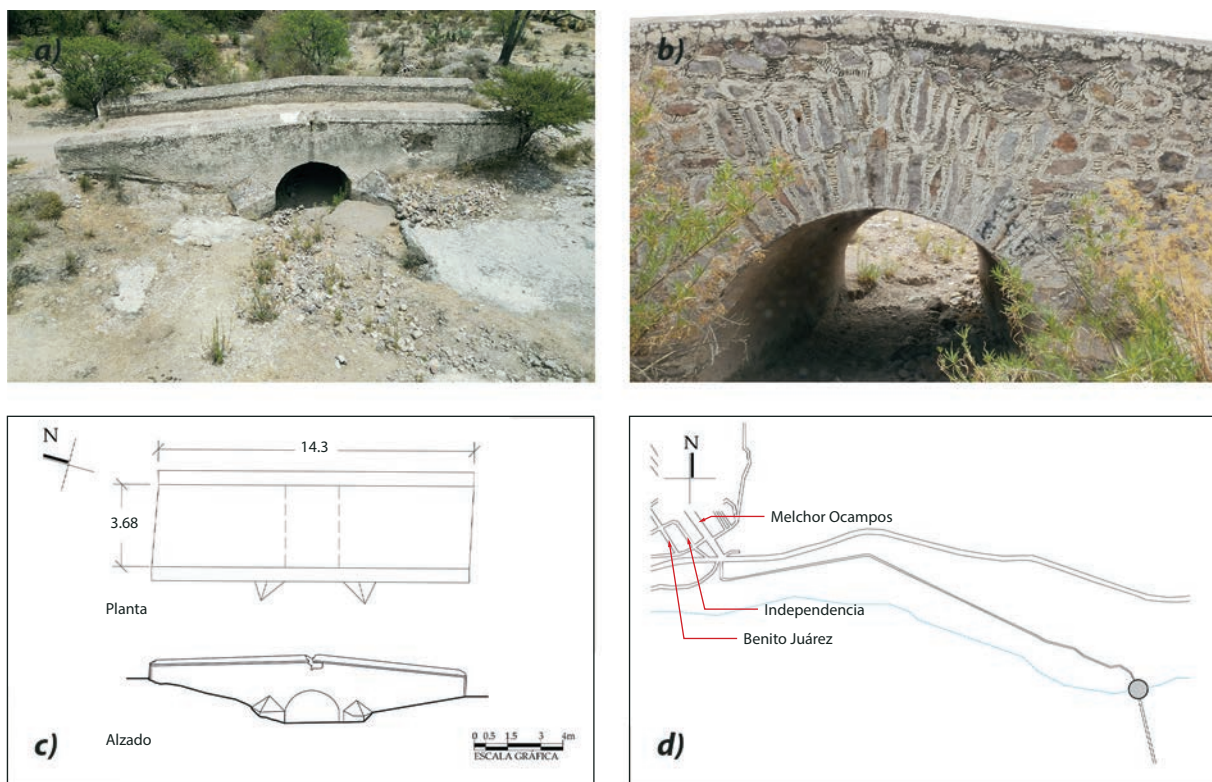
a) fachada oriente, b) detalle de arco y dovelas, c) croquis arquitectónico y d) croquis de localización del Puente Blanco.
